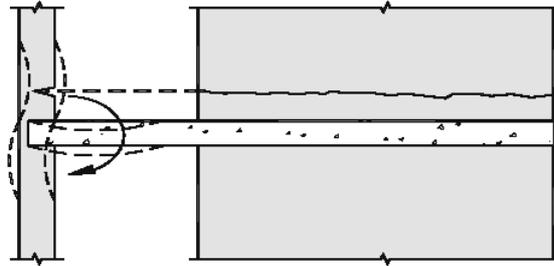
Fissura horizontal na base da parede provocada pela deformação excessiva da laje
